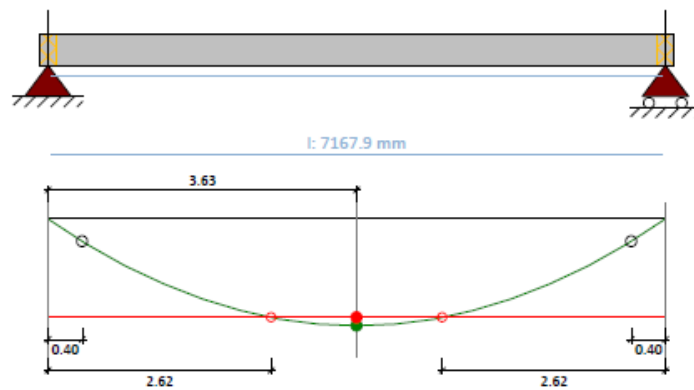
Reforzamiento en vigas FRP a flexión, Fuente: Propia
